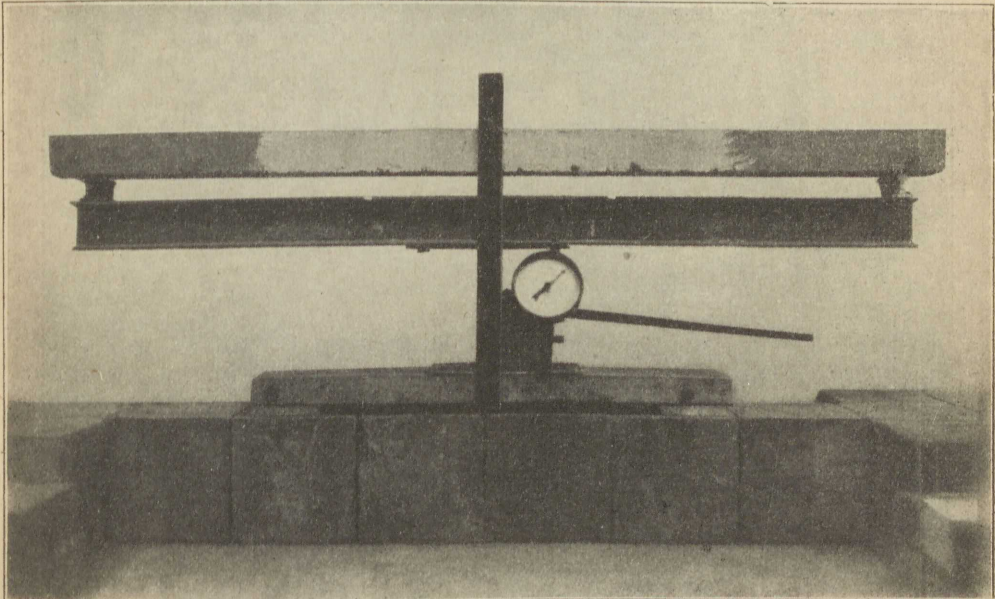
Prüfung von Eisenbetonbalken durch Einzellast mit Lastheber und Manometer.
